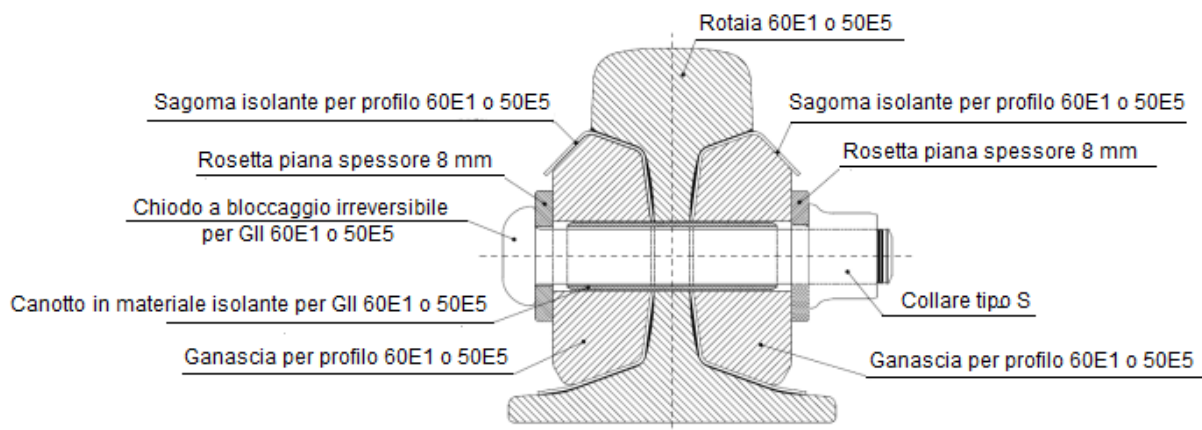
sezione trasversale della GII dell'armamento 60E1 / 50E5
